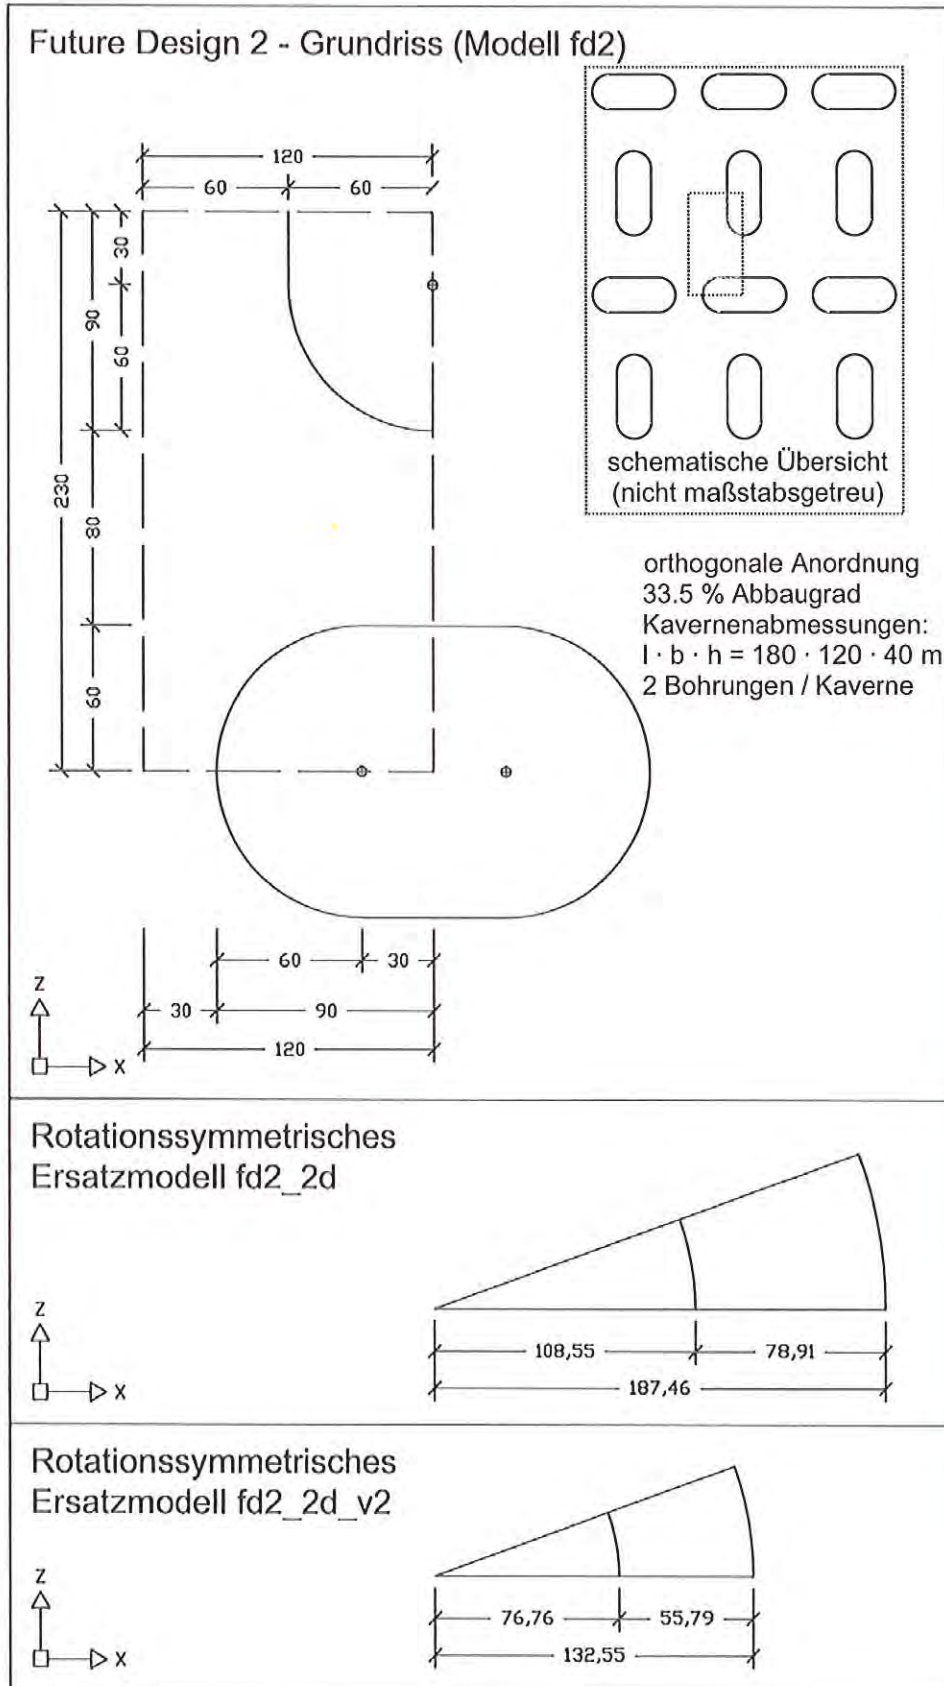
Future Design 2 – Grundriss und rotationssymmetrische Ersatzmodelle
